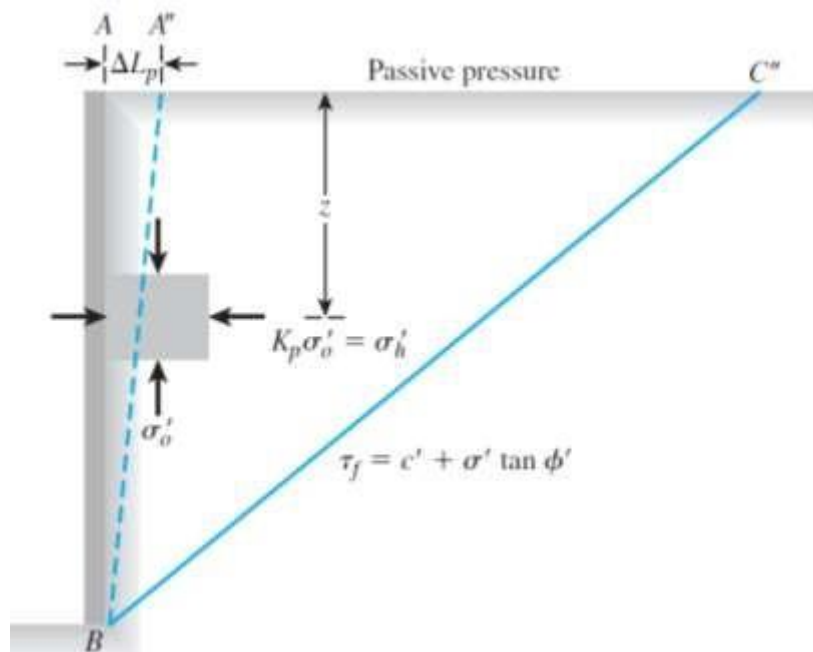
Estado pasivo de suelo. Fuente: Principles of Geotechnical Engineering. Braja Das (2010).
